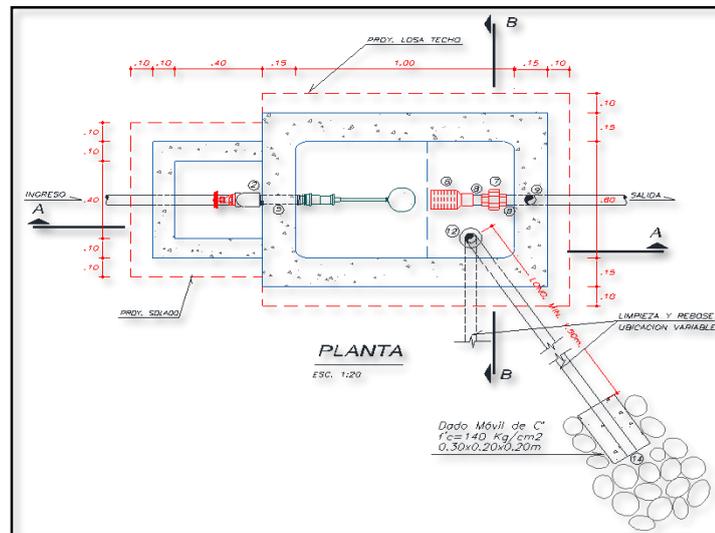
VISTA EN PLANTA DE CÁMARA ROMPE PRESIÓN 7 – CRP7
